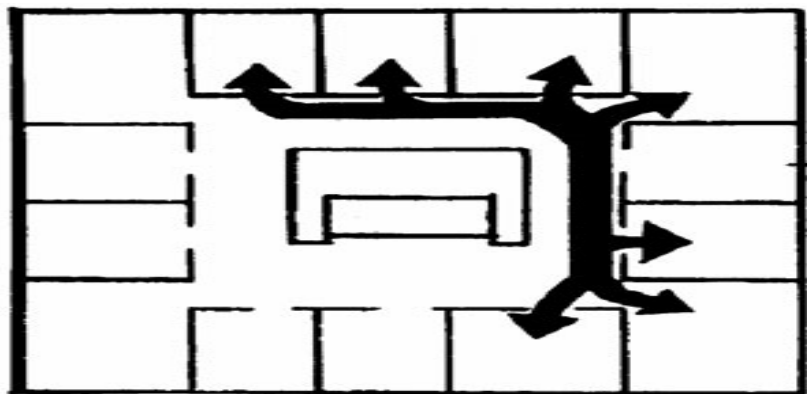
типовий план поверху будівлі каркасного будинку з важкими стінами.
